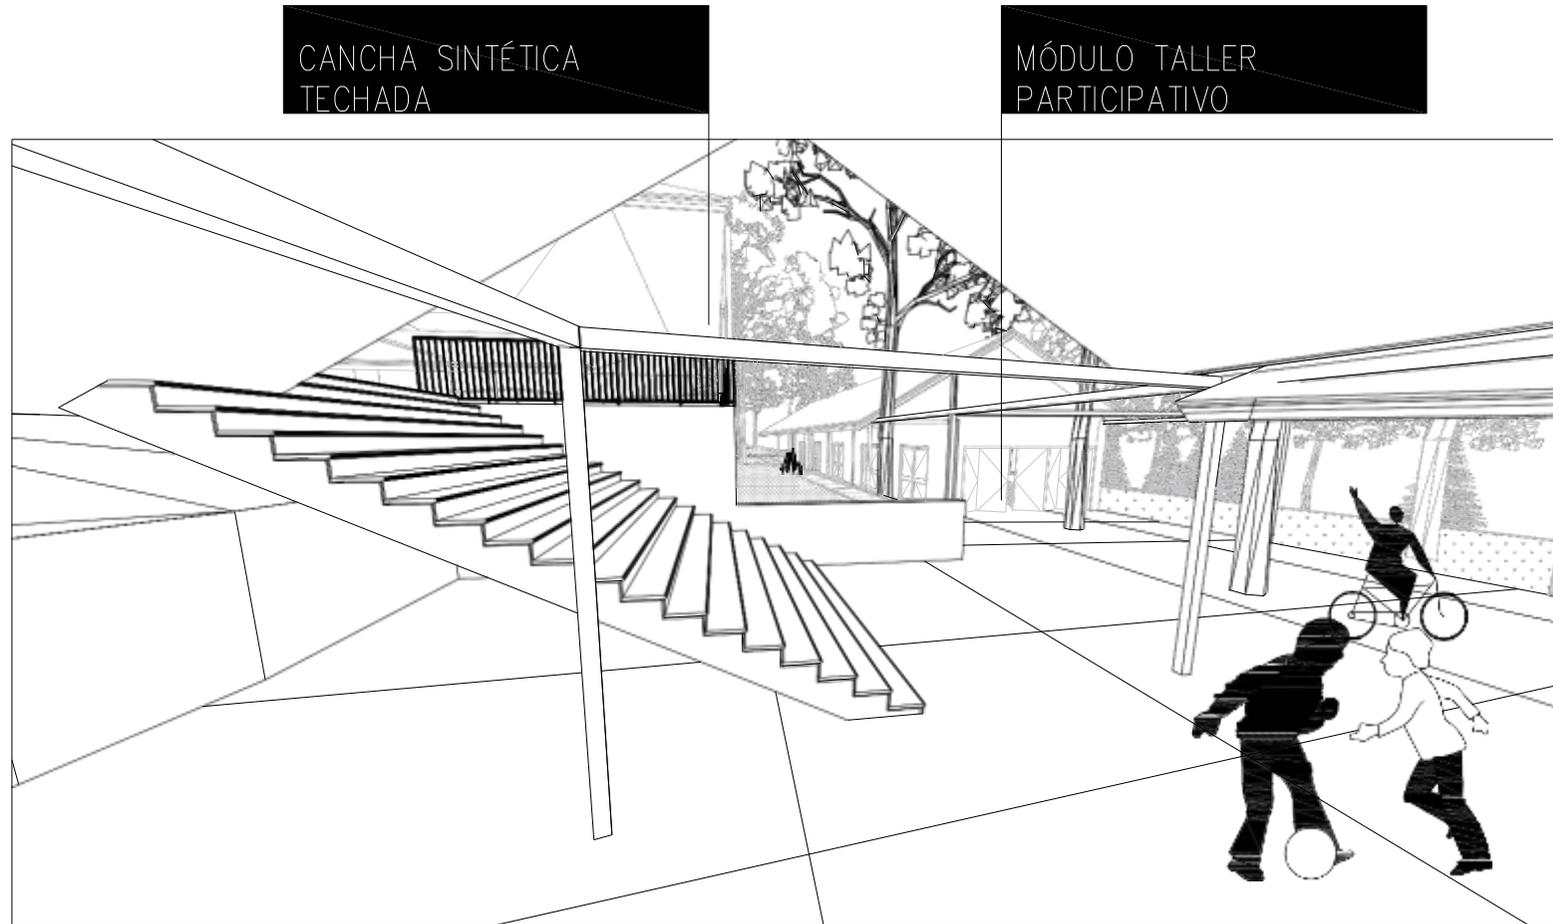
Vista de pasadizo techado para el área de capacitación rural.
